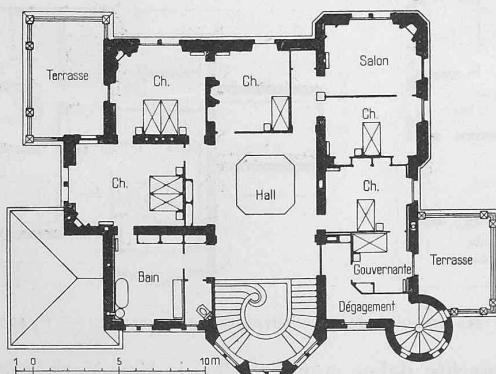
Plan de l'étage supérieur de la villa Fallot. — Echelle 1 : 400.
